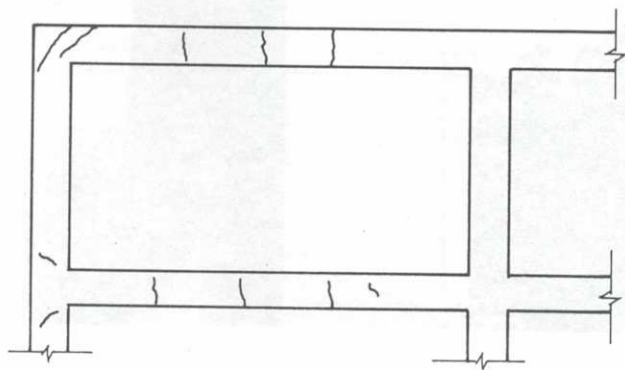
Trincas nas peças estruturais: a expansão da alvenaria solicita o concreto à tração.
